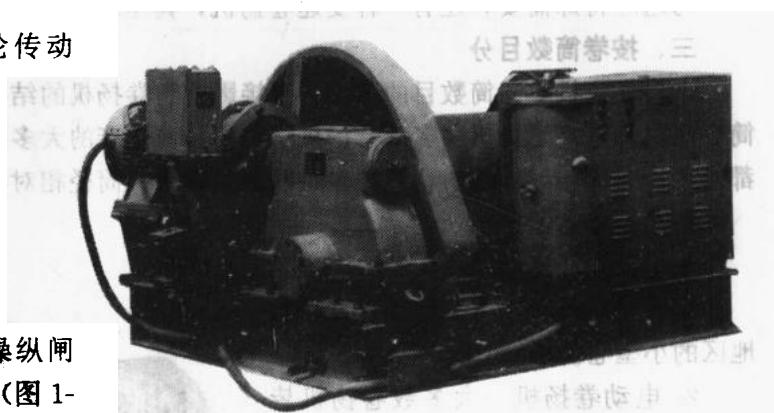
蜗杆减速器加开式齿轮传动卷扬机
